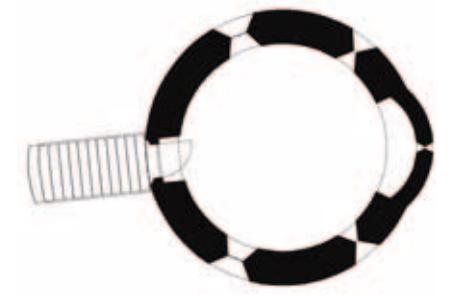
Grundrisse Maria Wörth M 1:200. TU Graz/Grünwald, Rottensteiner 2008.
